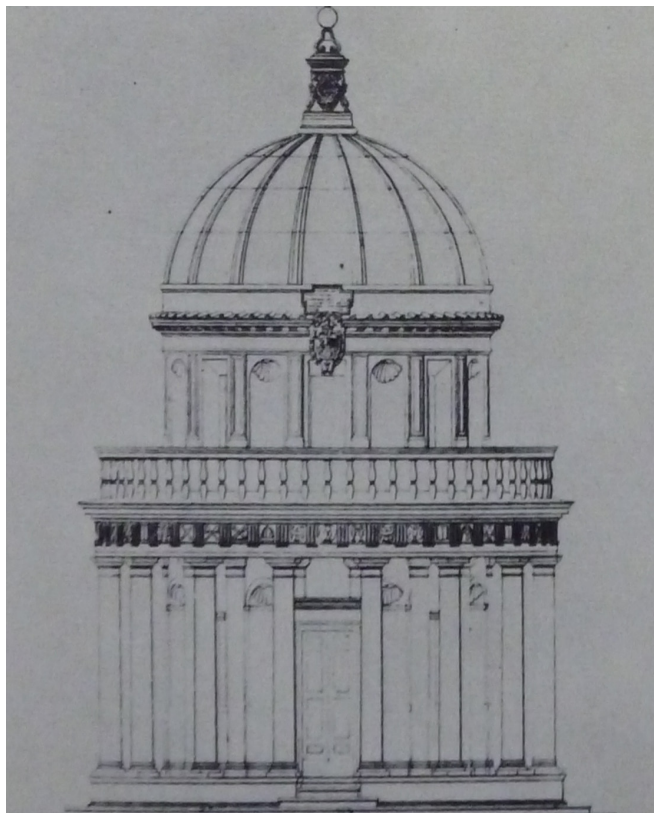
S.Serlio, Prospetto di S.Pietro in Montorio, Libro III c.c. 67\_seconda edizione
